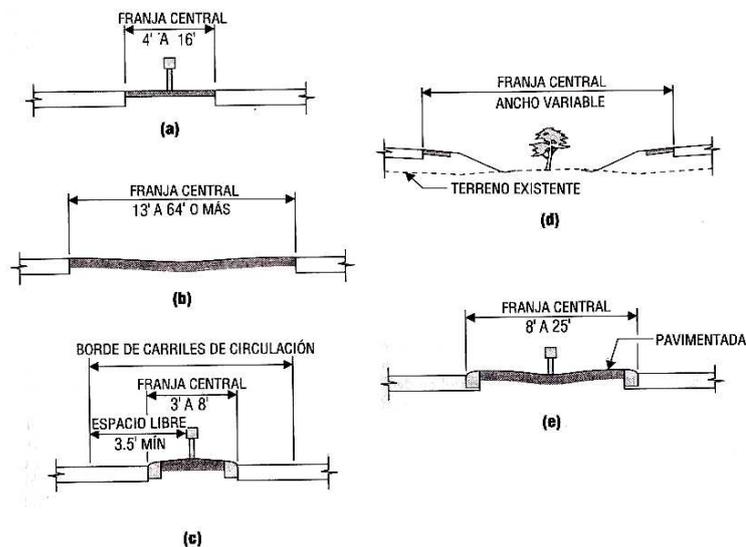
En esta figura se muestran secciones transversales de carreteras con franjas centrales de distintos tipos usuales. a) Pavimentada al ras; b) con terreno bajo y pavimentada al ras (con pendiente máxima 1:6) cuando el ancho de la franja es mayor de 36 ft; de lo contrario, pavimentada e incorporando una barrera en ella; c) elevada, con guarnición y combada, con ancho de 3ft cuando se instala la barrera opcional; d) terreno natural entre carreteras independientes; e) elevada, con guarnición y deprimida hacia la barrera.
